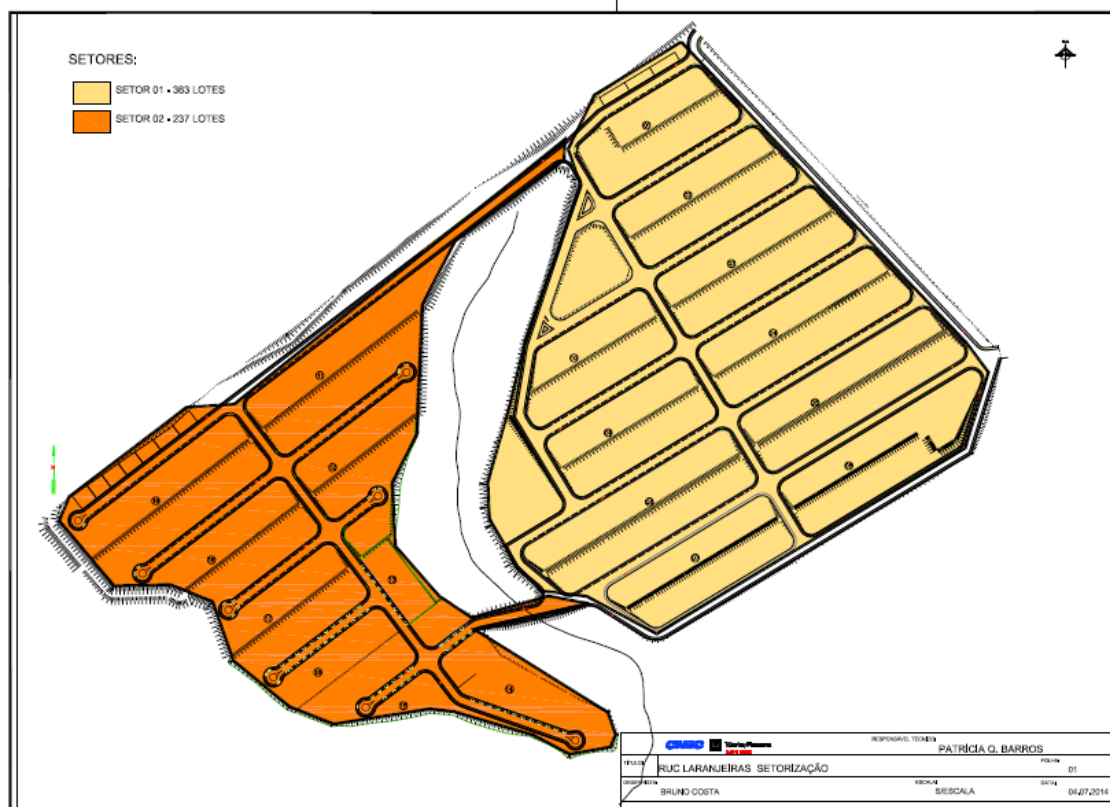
5 - Setorização do bairro Laranjeiras.
